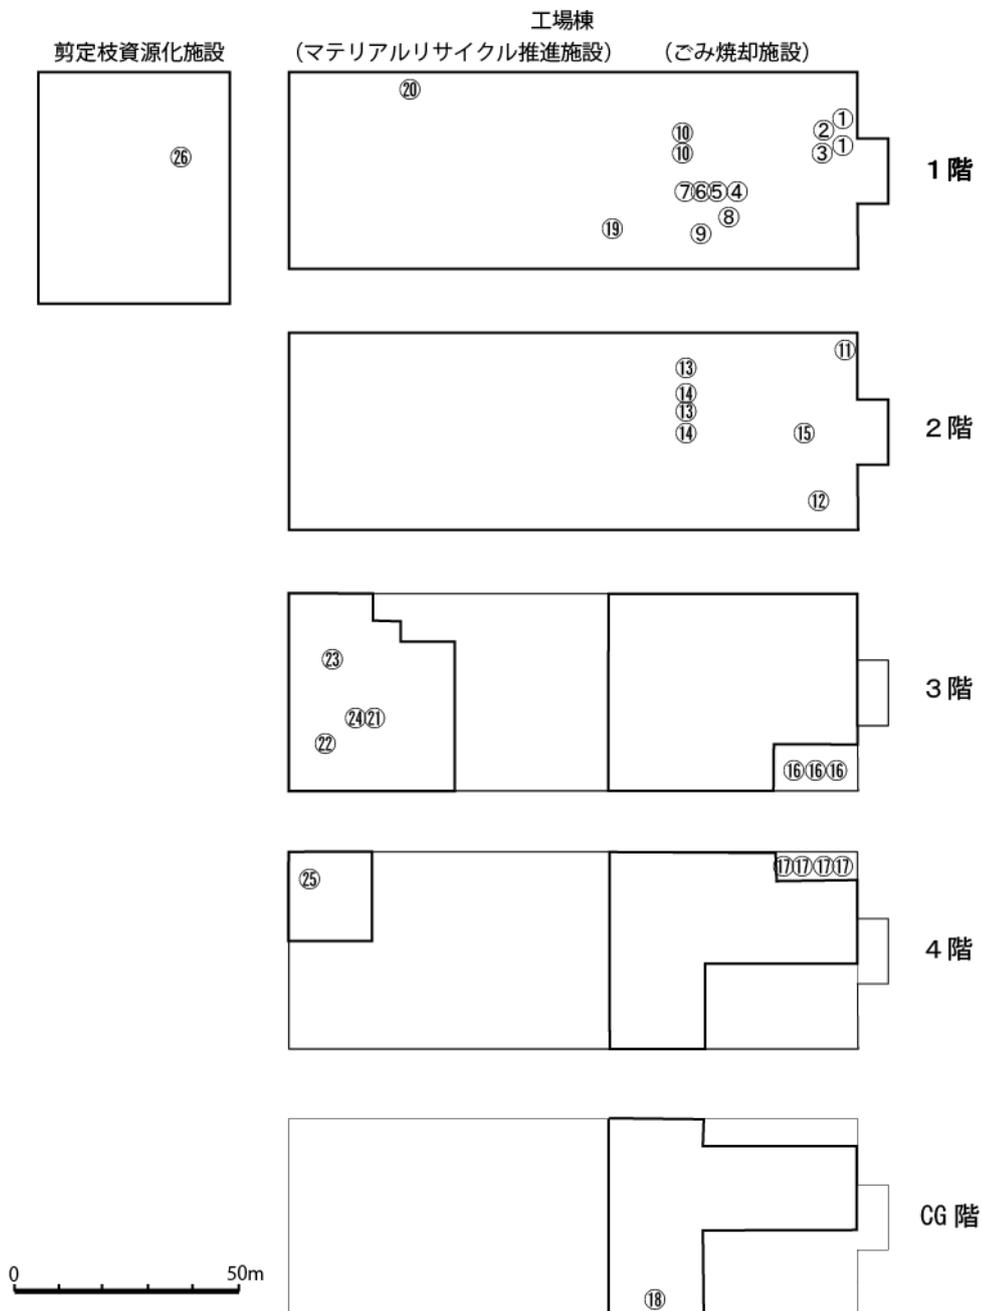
騒音が発生させる主要な設備機器の配置(想定)図(平面図)
